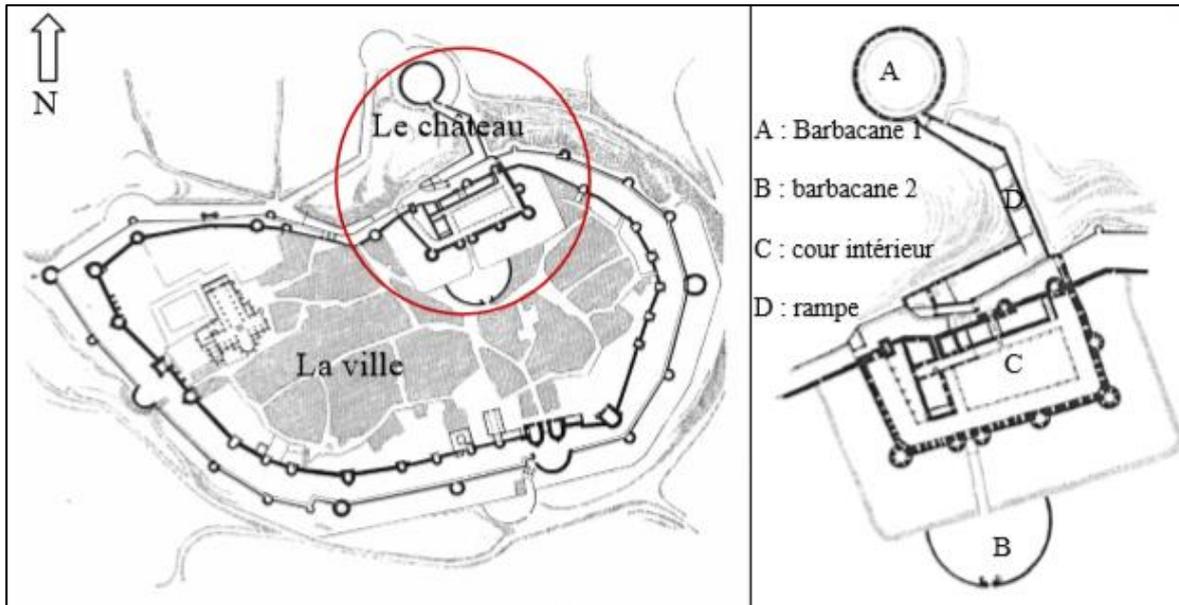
Plan de la ville de Carcassonne, et le plan de son château
